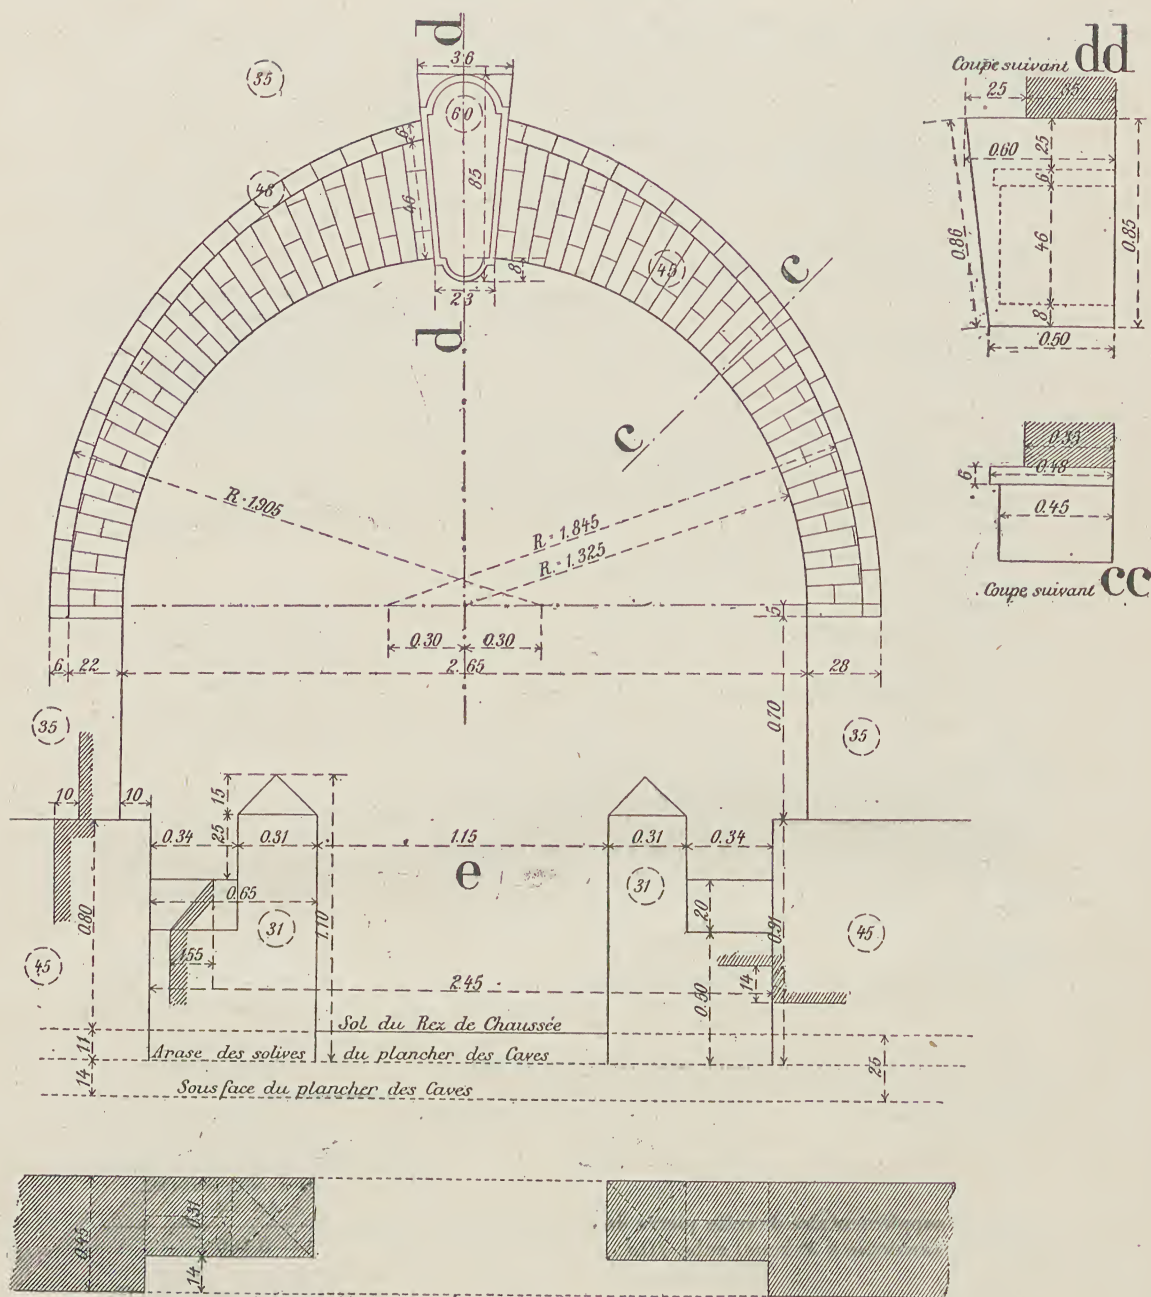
à 593. — Elévation, Coupes et plan de la porte d'entrée.
